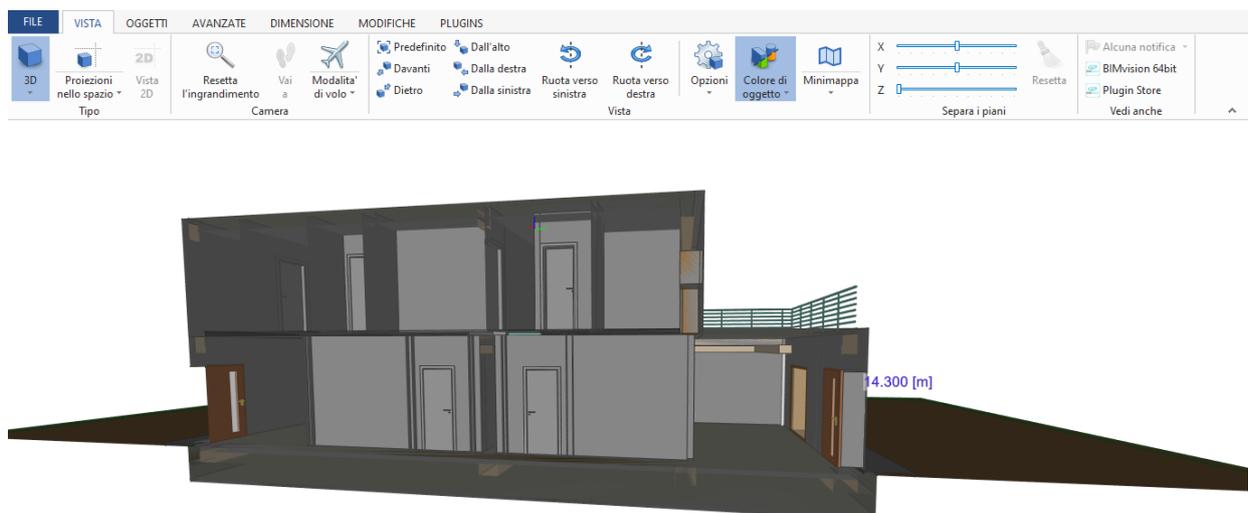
Sezione tridimensionale modello architettonico e strutturale in BIMvision
